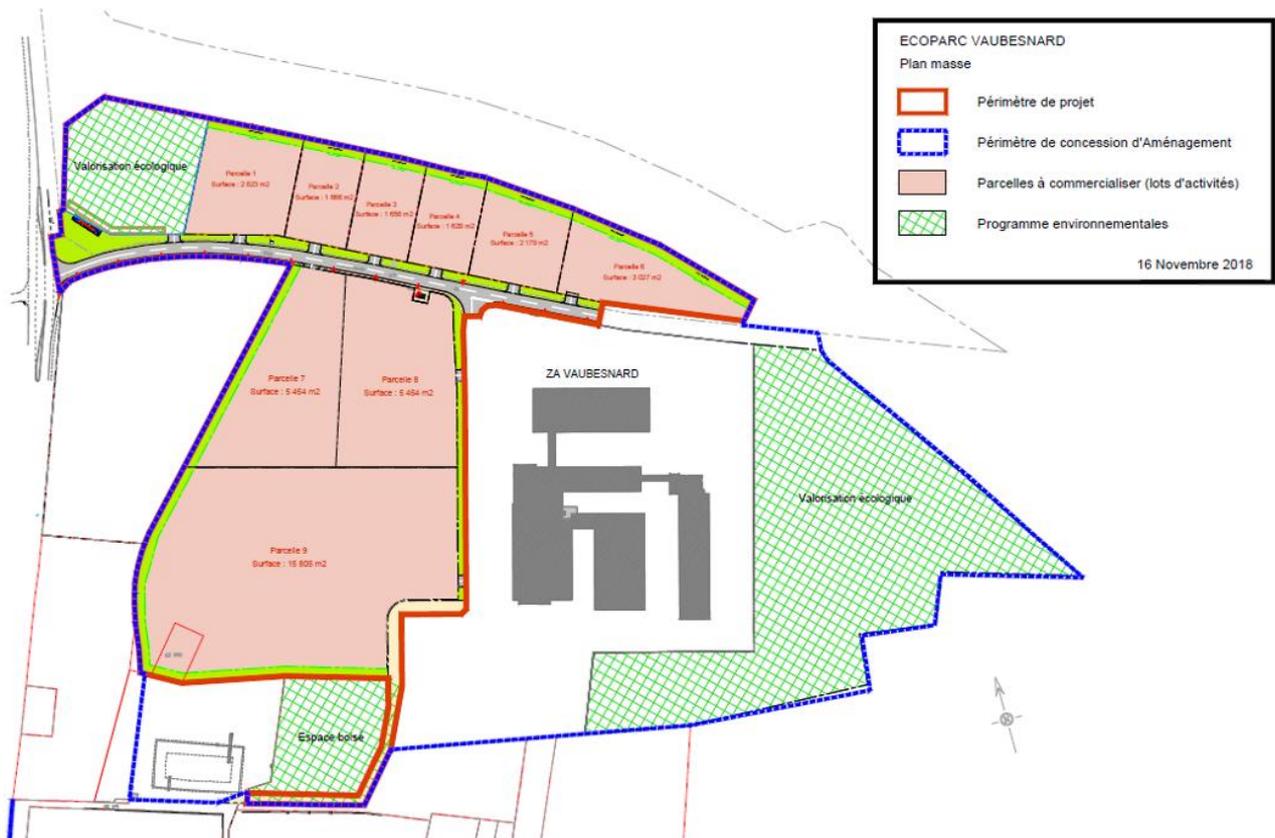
Plan masse du projet (source : étude d'impact, page 6)
